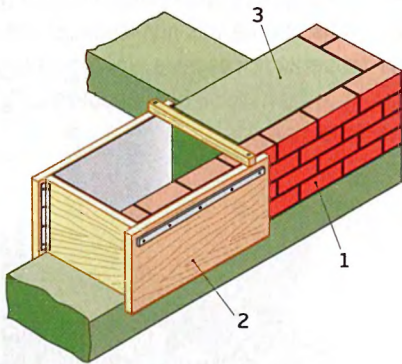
Формование блоков с одновременной облицовкой стены: 1 — облицовочный кирпич; 2 — форма; 3 — формовочная смесь.
